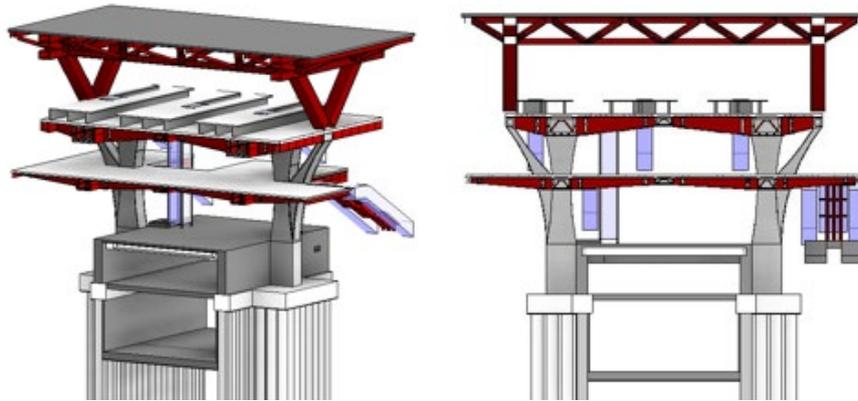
Sistemas de la estación y el paso inferior: vista 3D y sección. Fuente: SENER Ingeniería.
